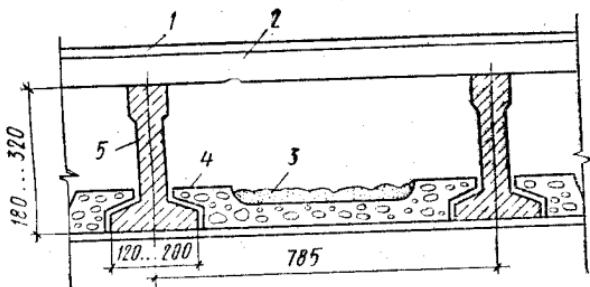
Конструкции для замены перекрытий с железобетонными прогонами двутаврового сечения:
